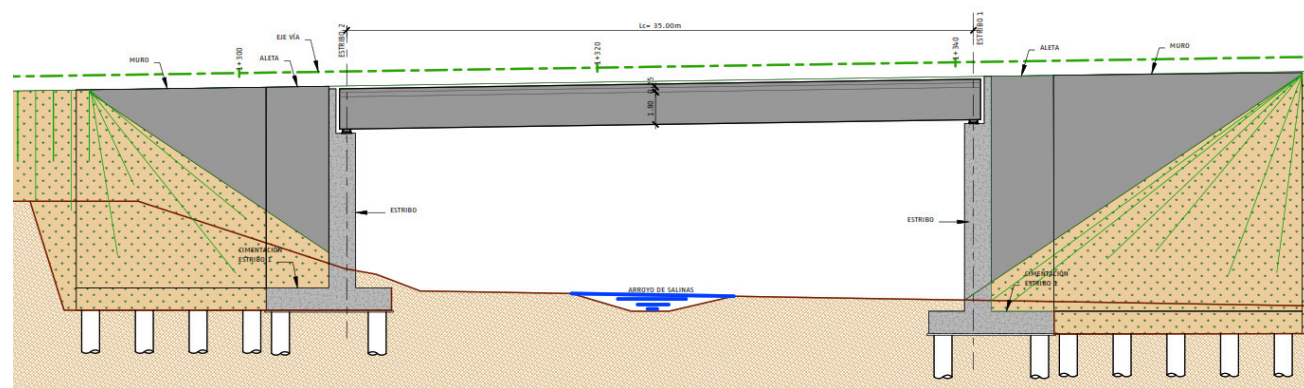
Alzado. Vdto. Arroyo de las Salinas.
